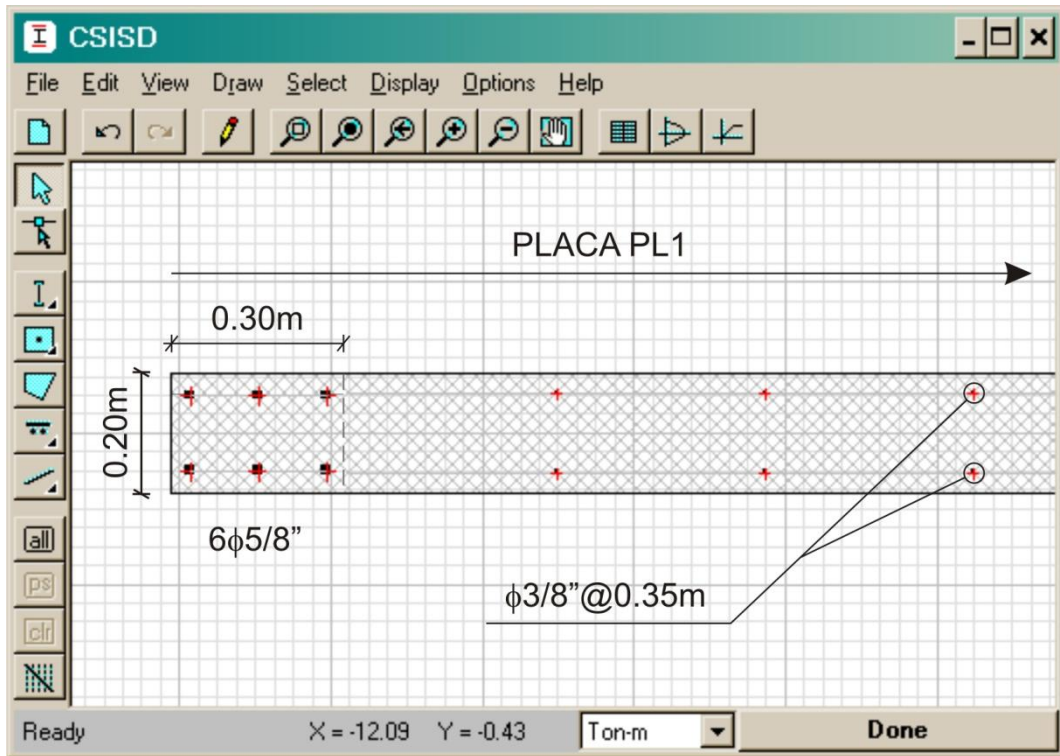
Refuerzo inicial colocado en el muro, dibujado en el Section Designer.
